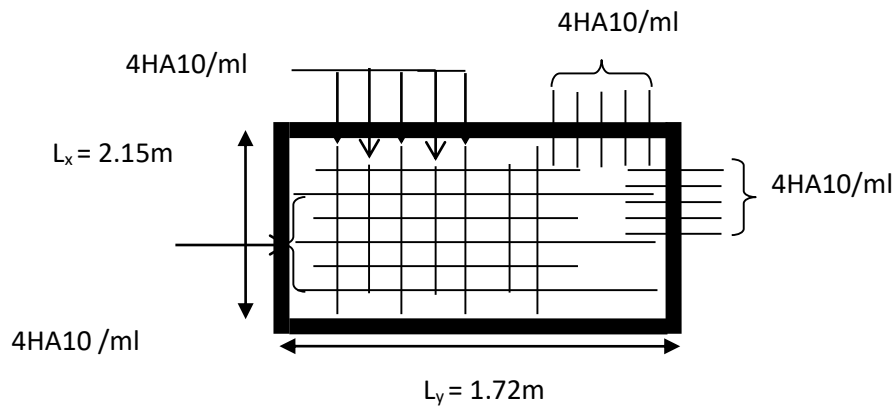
Schéma de ferrailage de la dalle pleine du locale des machines.
